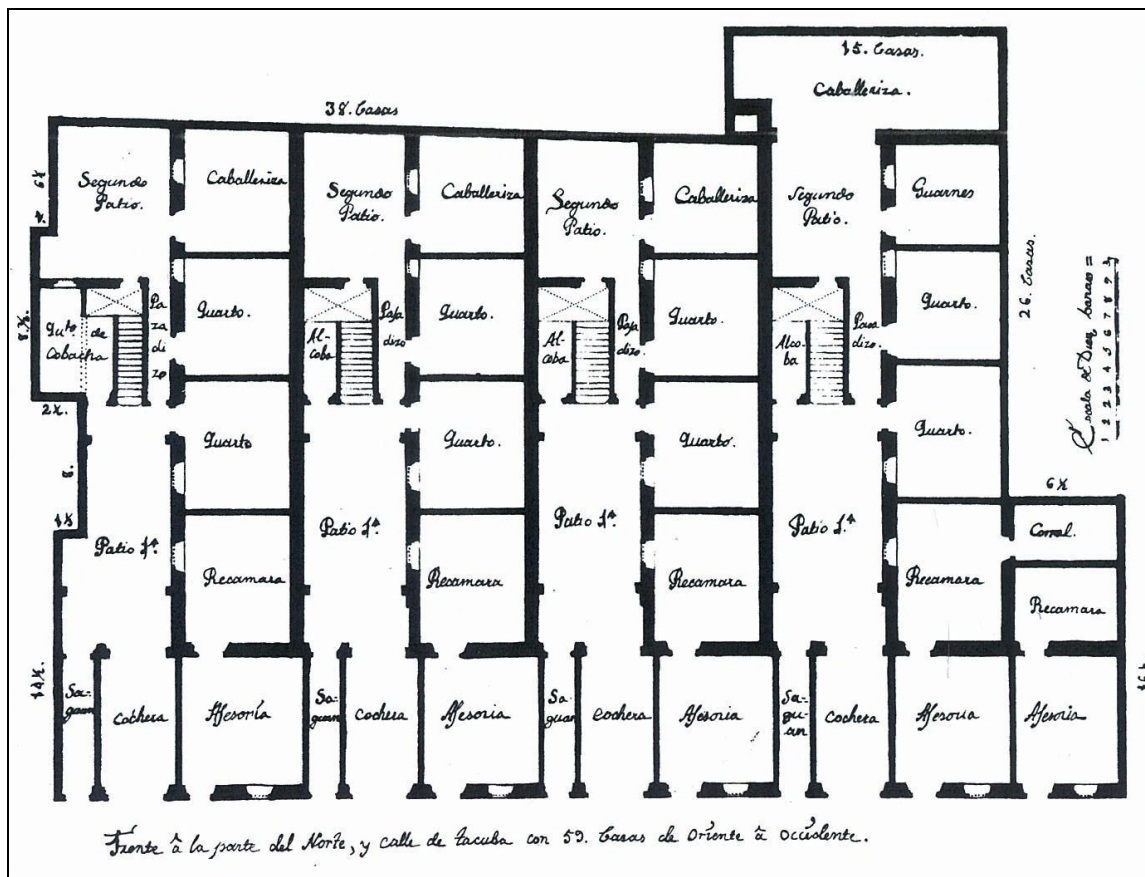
Bloque de viviendas en la calle de Tacuba, siglo XVIII, planta baja (*Vocabulario arquitectónico ilustrado*, p. 7)
